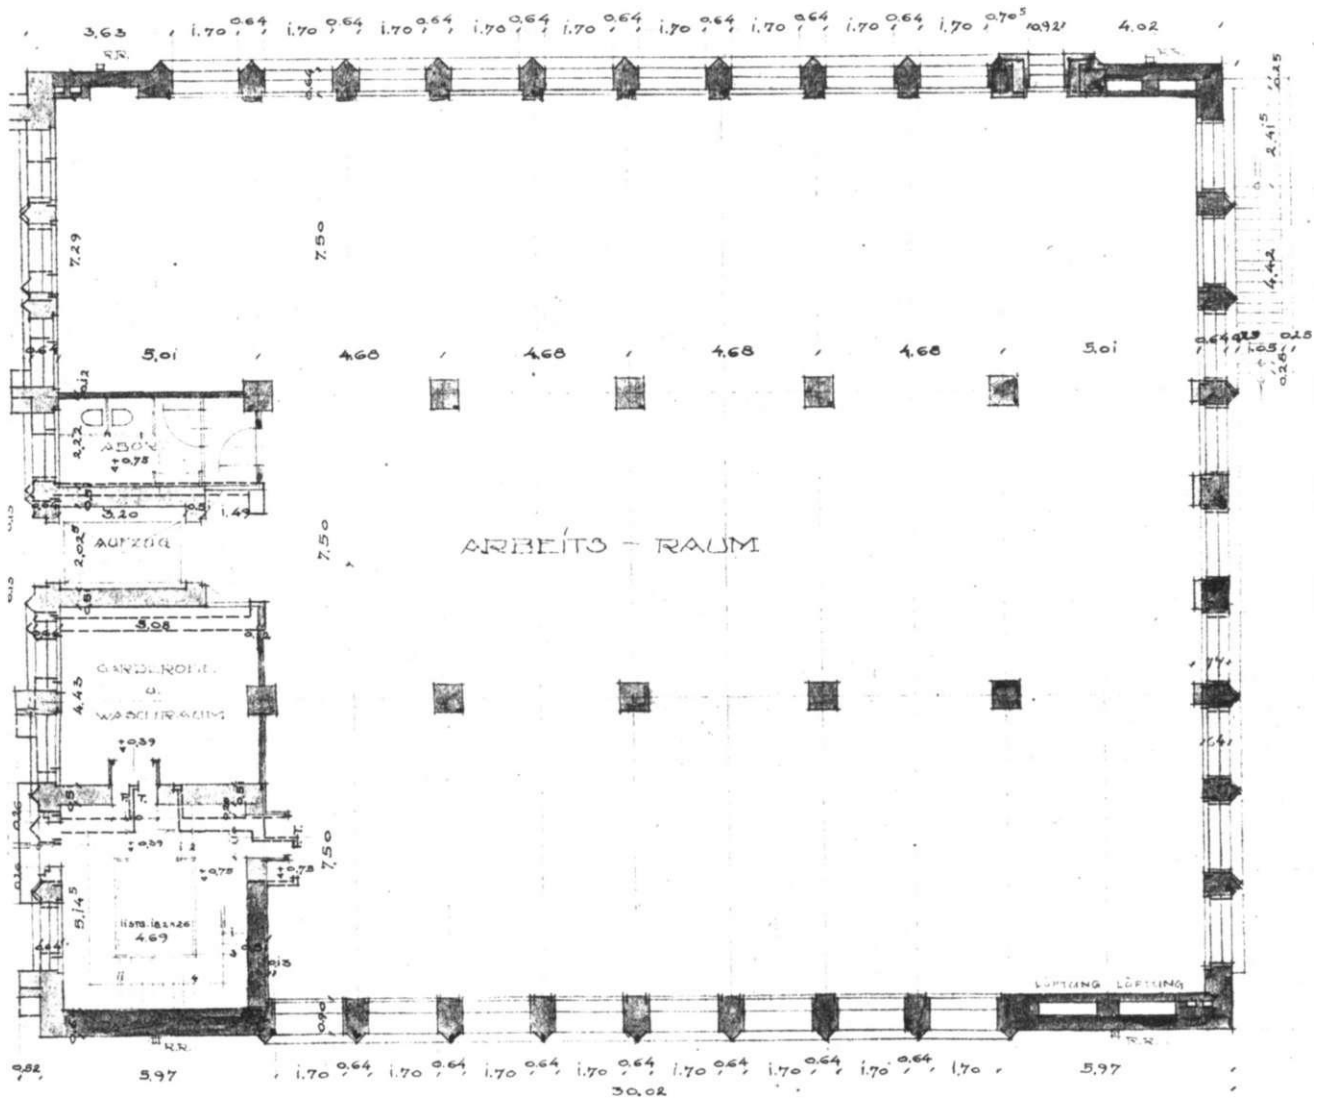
Liebknechtstraße 65-91, Erdgeschoßgrundriß der Modelltischlerei 1925
